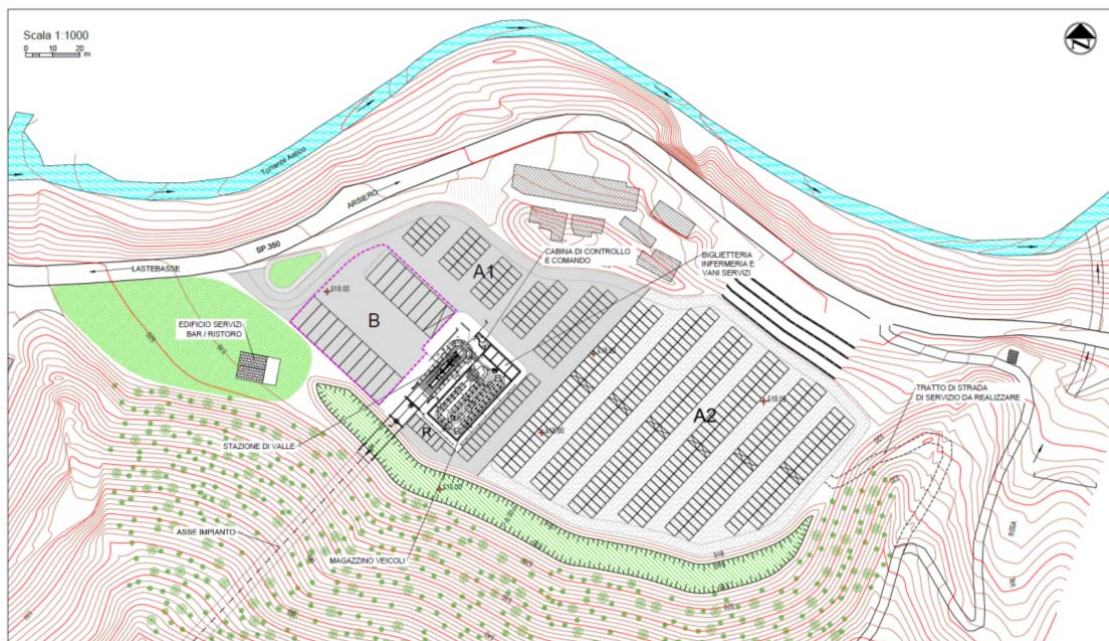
Planimetria Stazione di Valle fonte Progetto Preliminare 2012 Comune di Lastebasse
